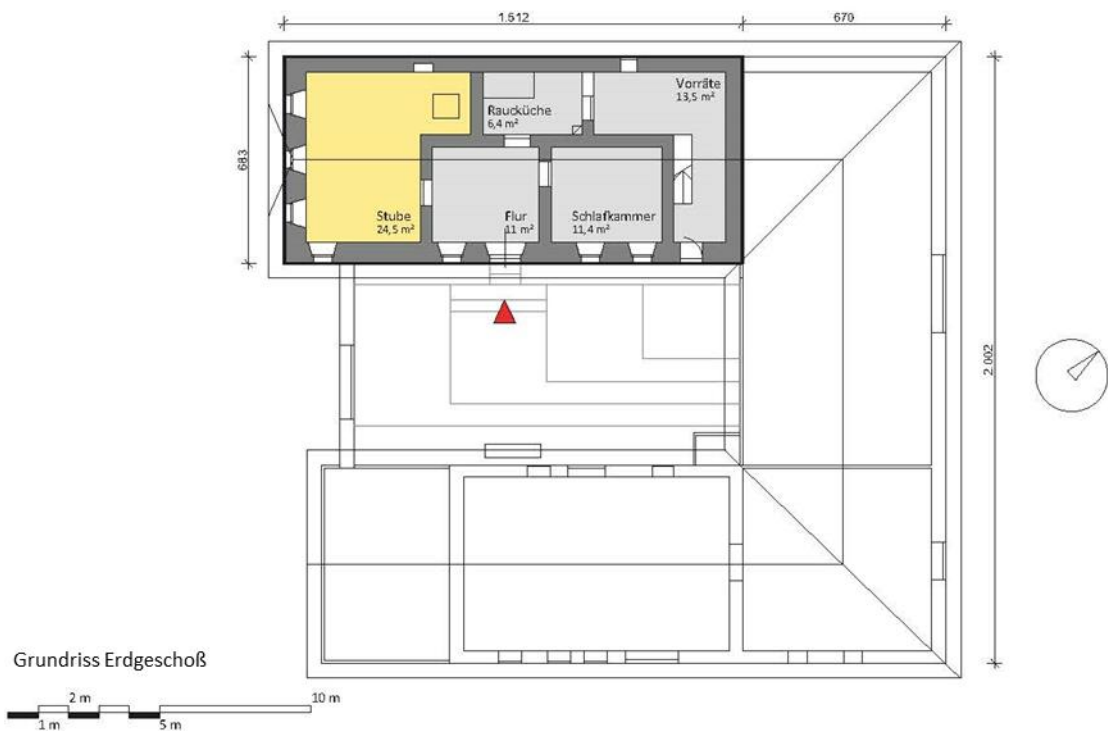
Grundrissdarstellung des Wohnbereiches
